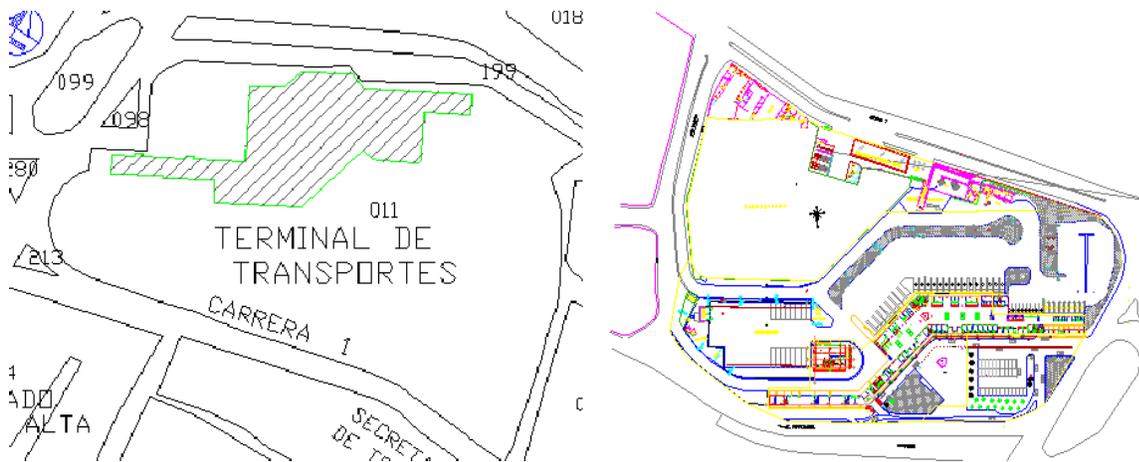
Planta arquitectónica terminal de Ibagué planta 1. suministrada por terminal de Ibagué.
